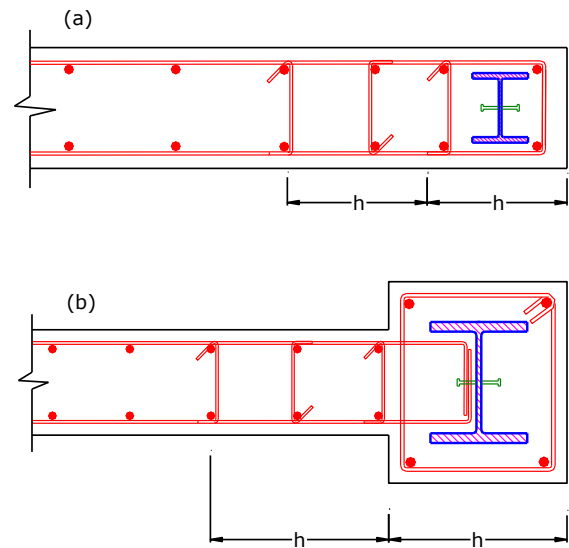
Muros de hormigón armado con elemento compuestos en los bordes (a) muro de sección rectangular, y (b) muro con ensanchamiento de bordes.
